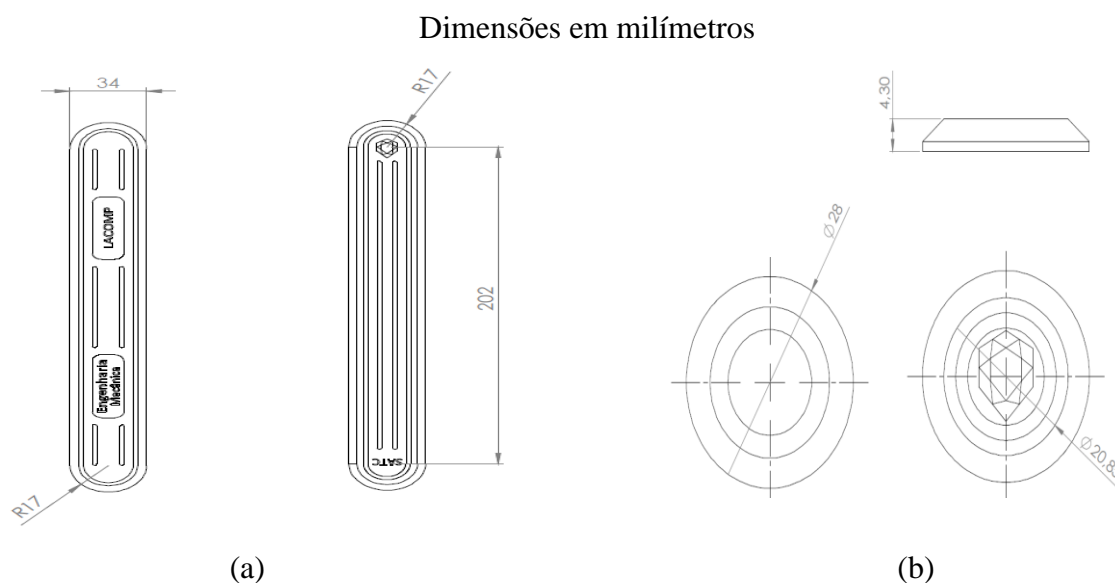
Projeto do piso tátil. a – Piso direcional elemento. b – Piso alerta elemento.
